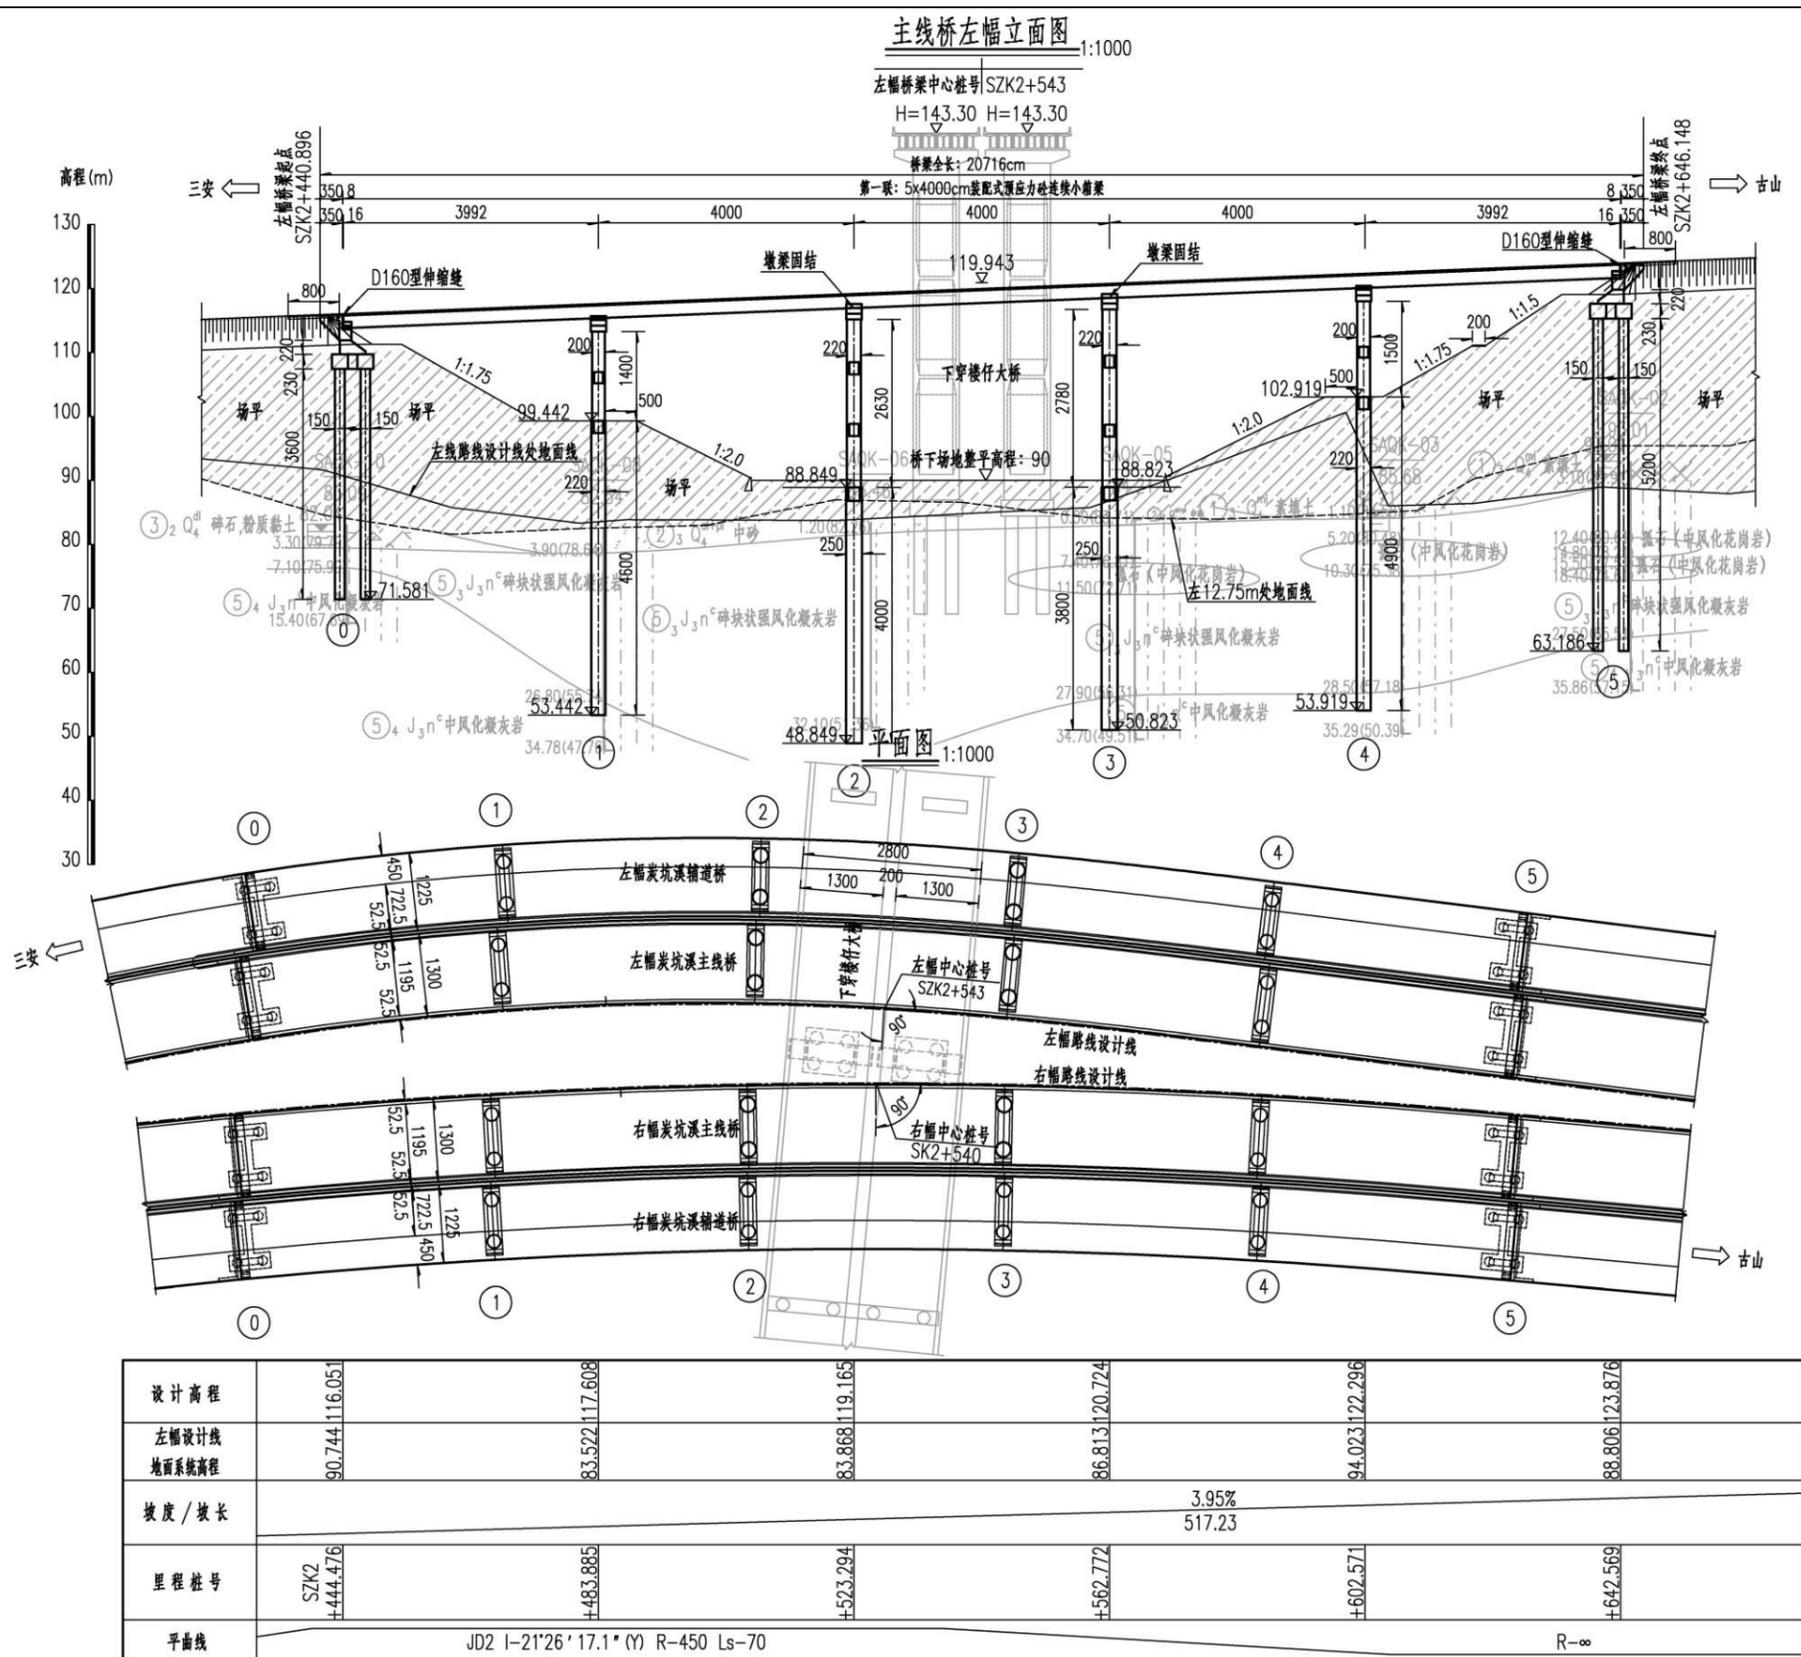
本项目炭坑溪大桥主线桥左幅立面图
